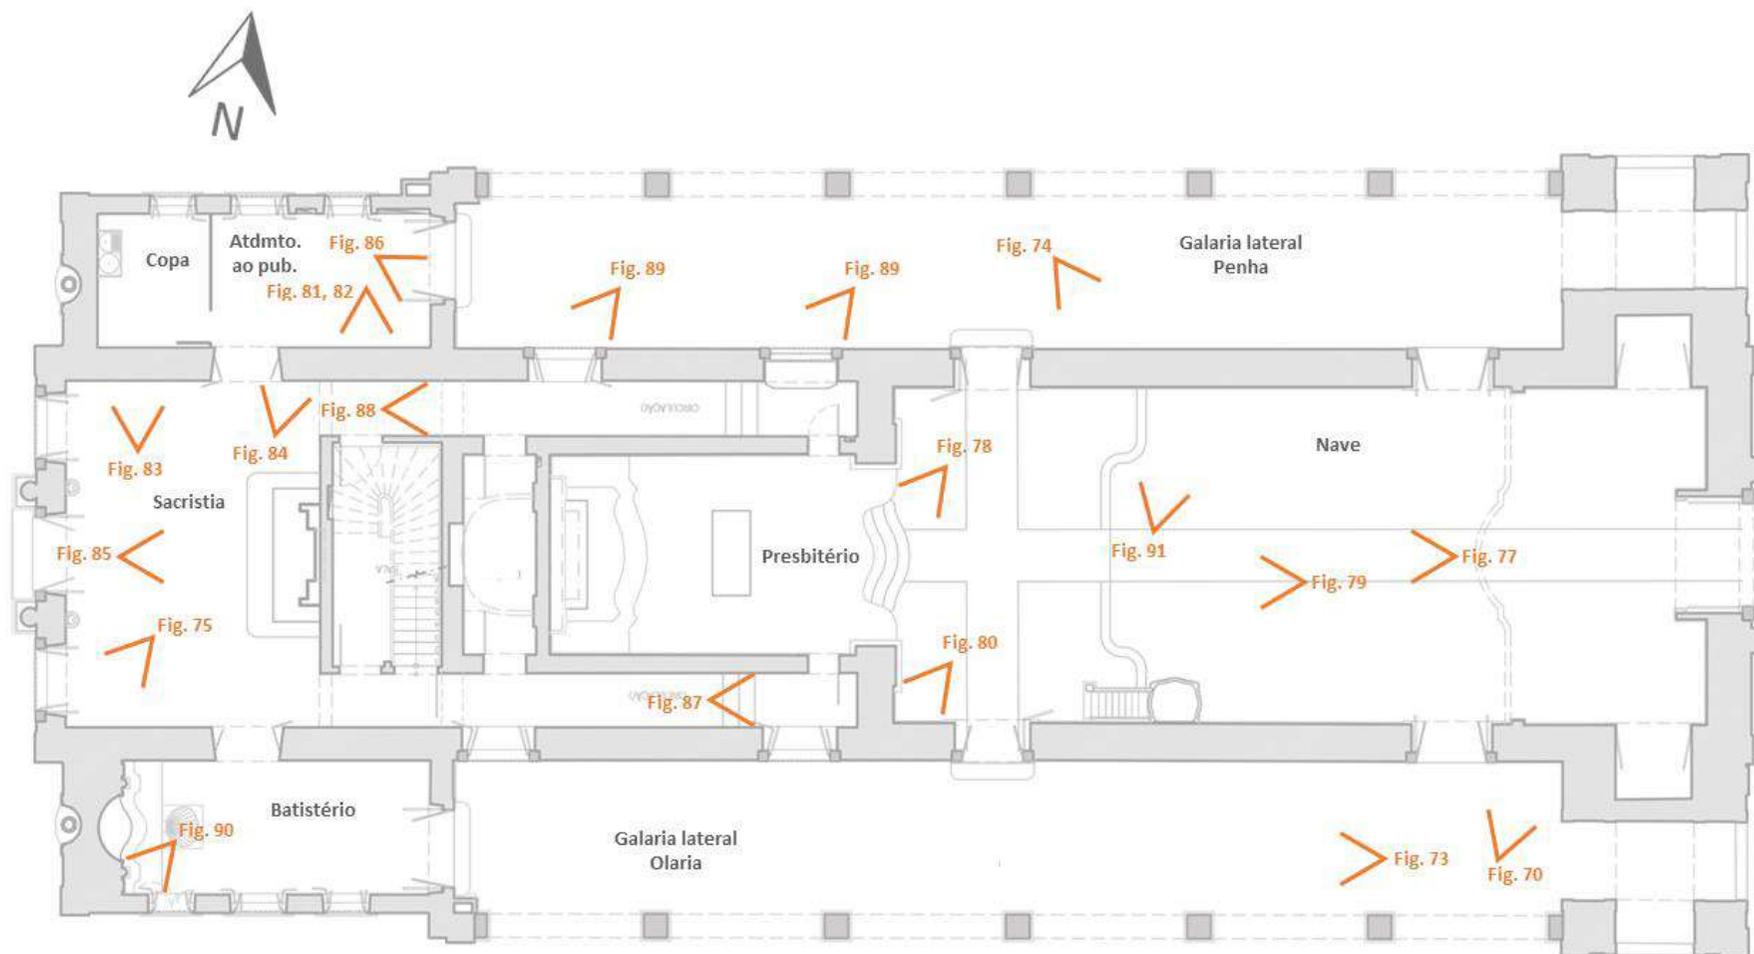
Localização das figuras presentes do subitem de materiais e sistemas construtivos, pavimento térreo.
